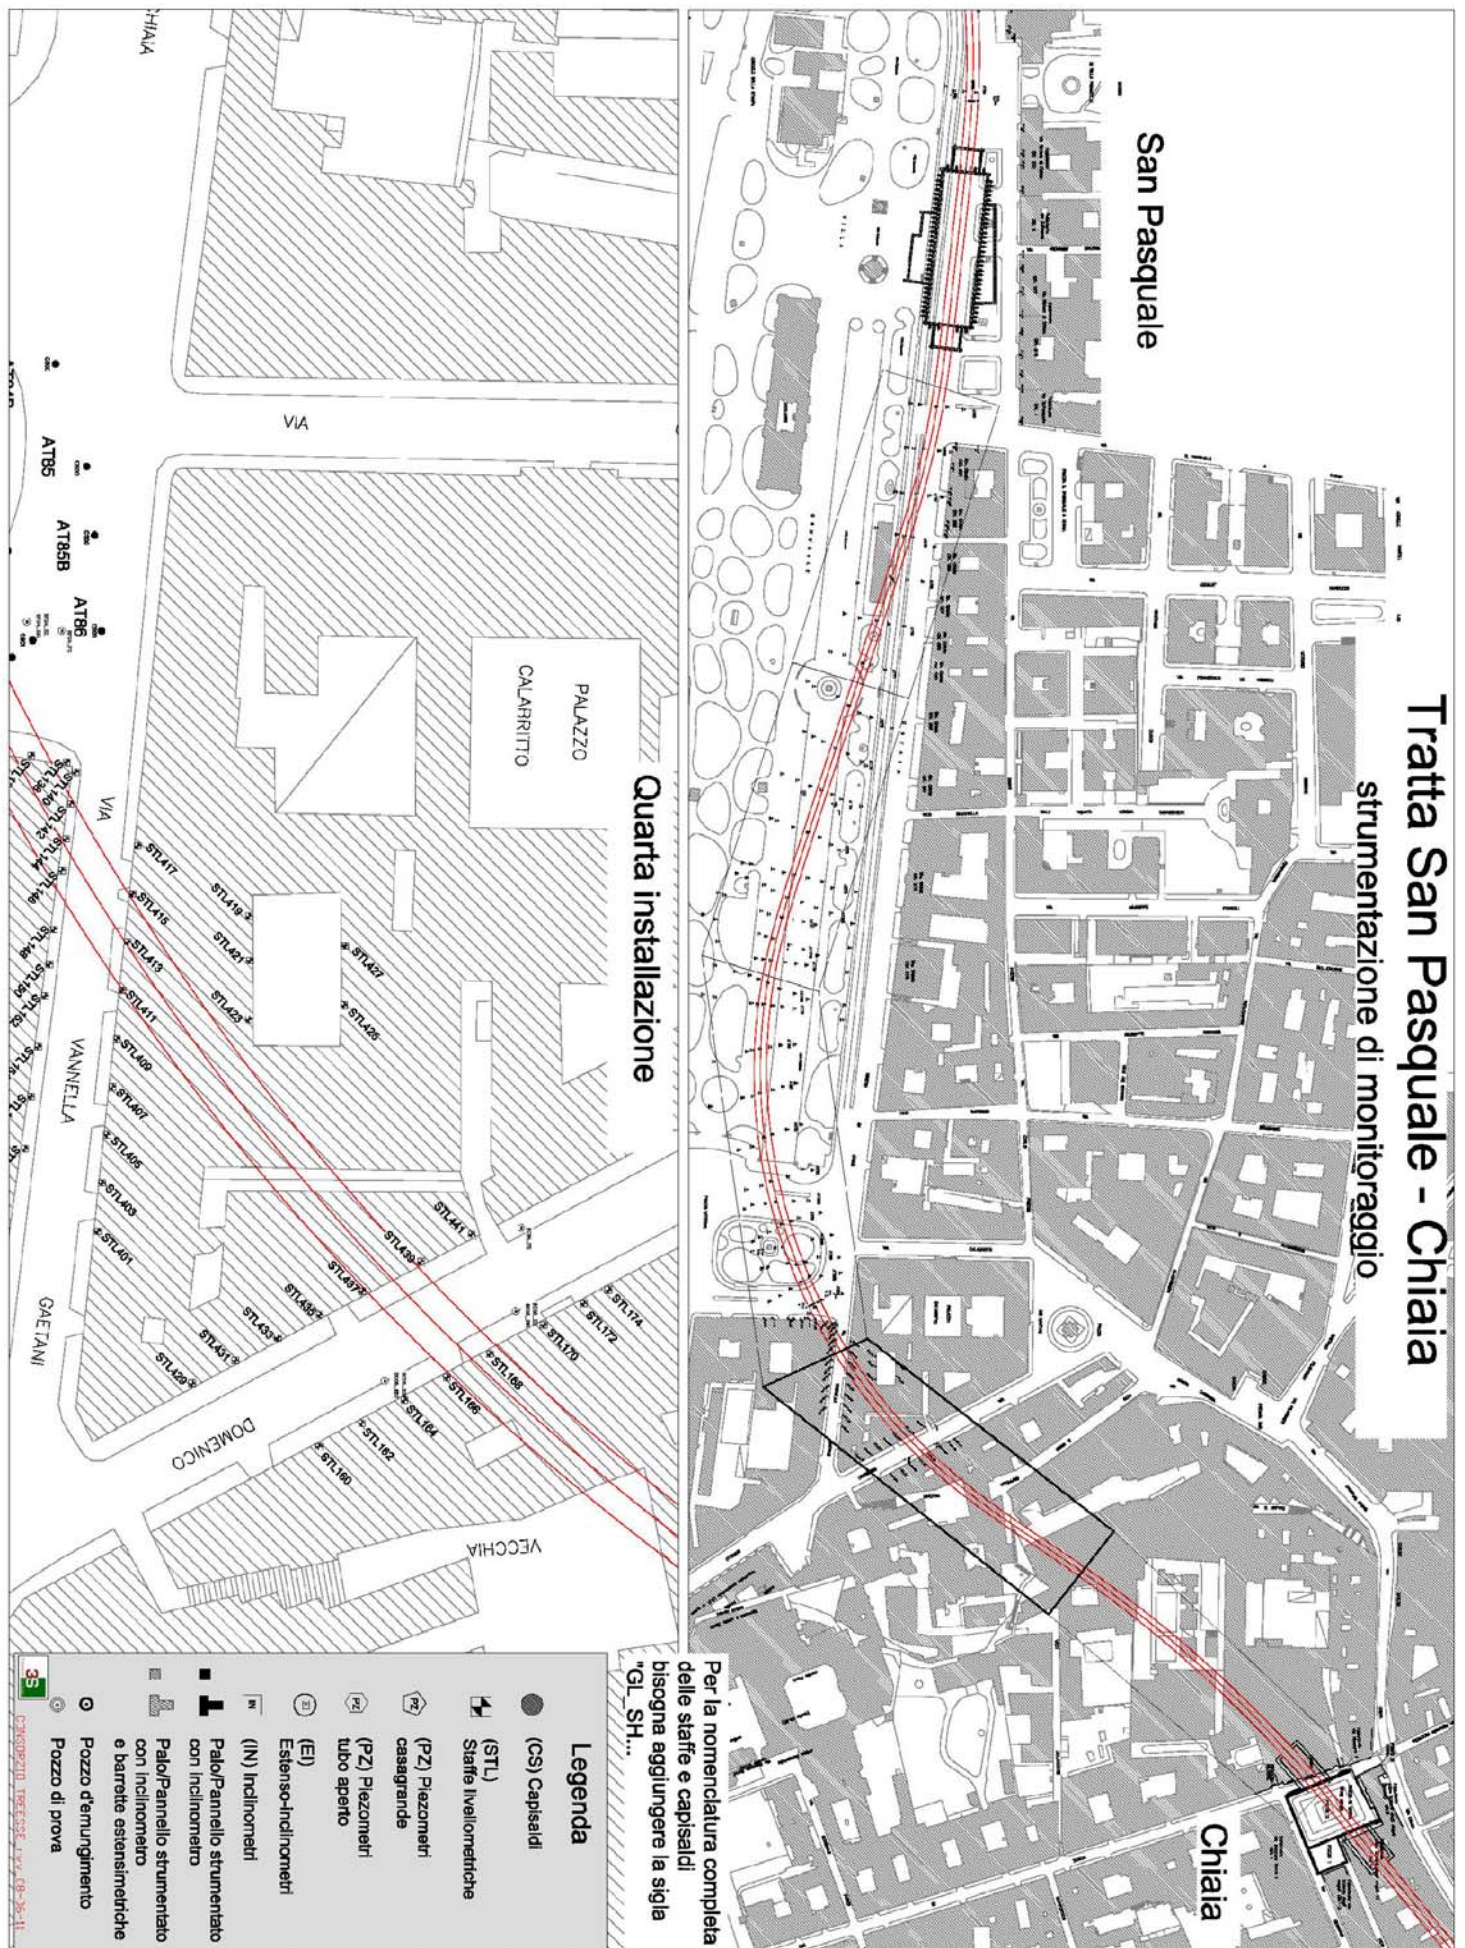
Planimetria tratta San Pasquale - Chiaia, raffigurante la disposizione della quarta installazione della strumentazione di monitoraggio.
